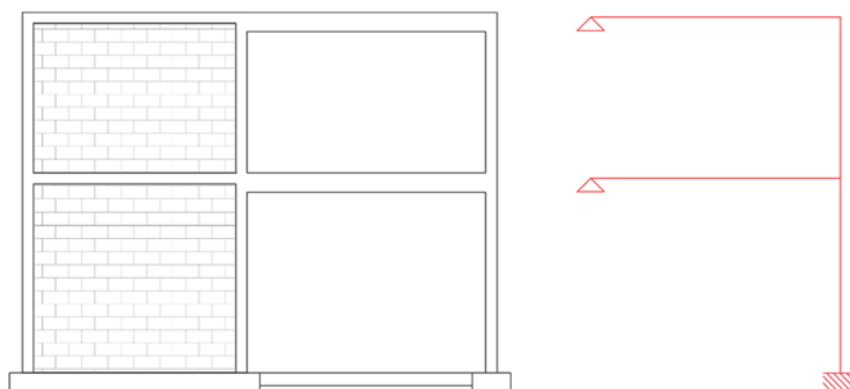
Pórtico apoyado en muro de mampostería y su modelado
